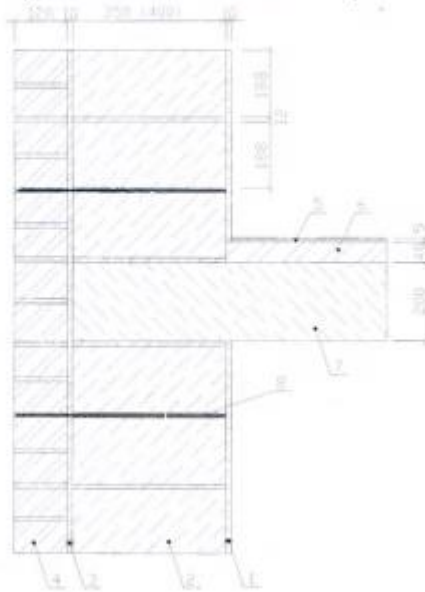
Вертикальное сечение по наружной стене:
